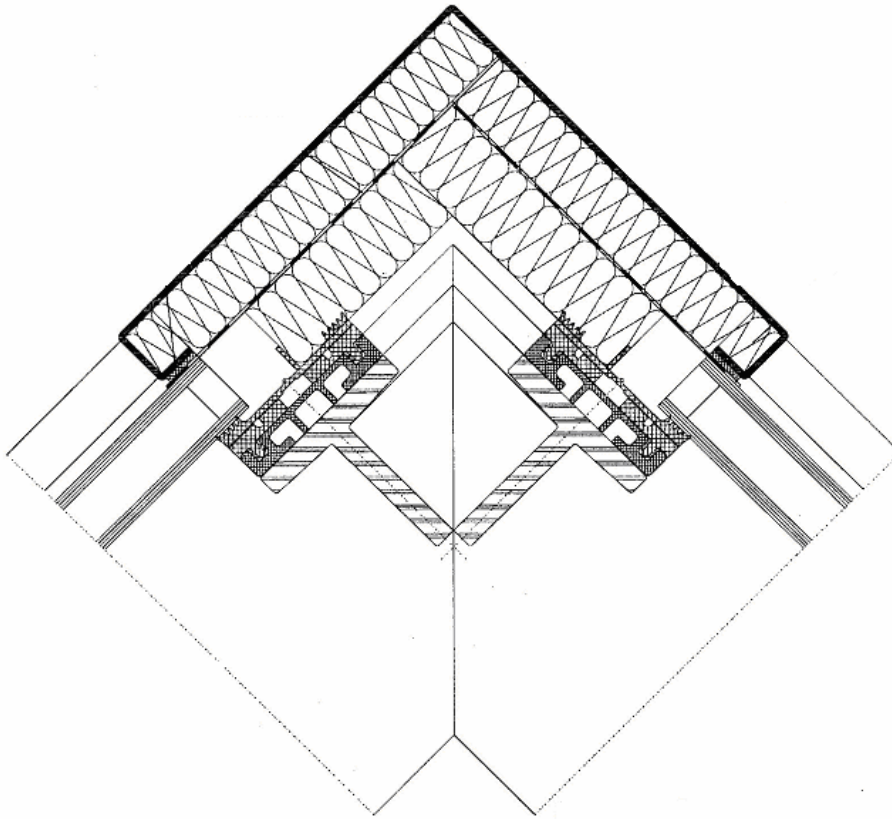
Coupe en partie haute sur un raccordement sur mur
